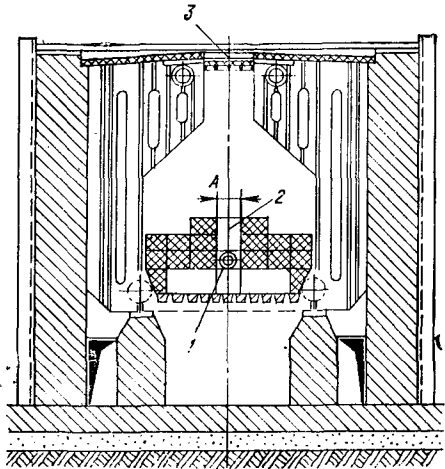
Установка горизонтальной (подовой) щелевой горелки низкого давления без принудительной подачи воздуха на котле «Универсал-4»
